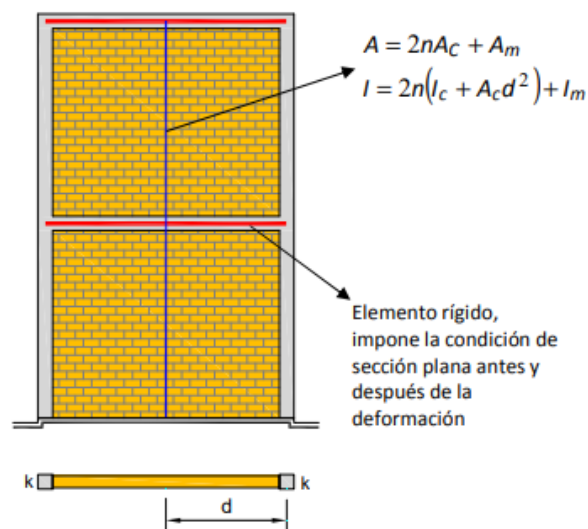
Muro modelado con columna ancha (Sociedad Mexicana de Ingeniería Estructural, 2019)
